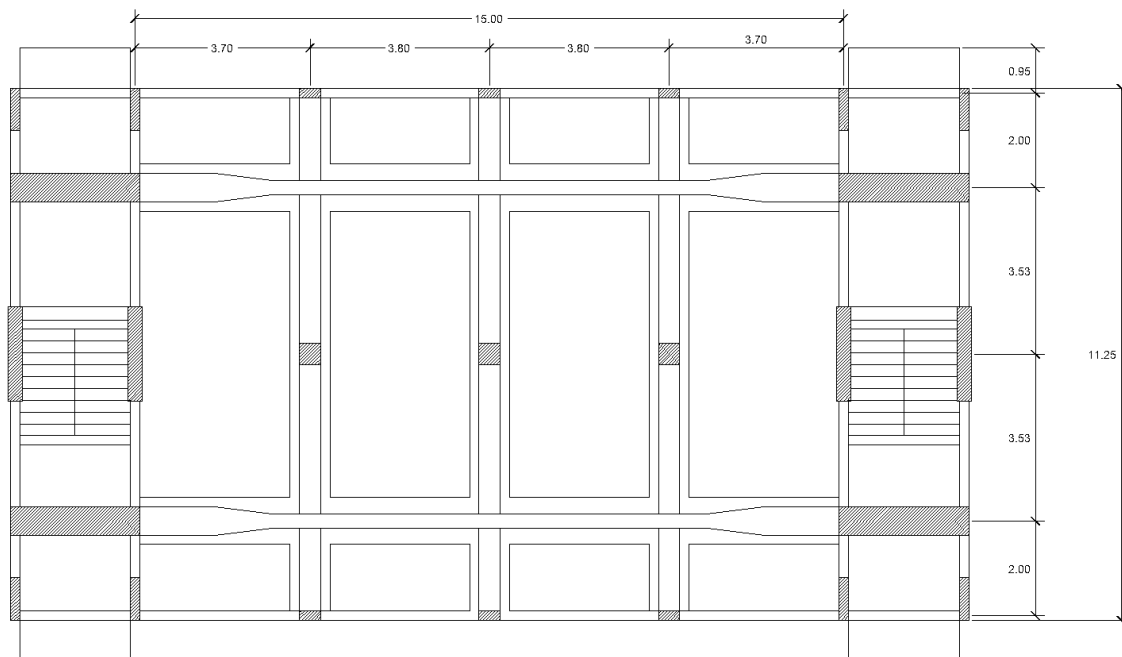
Croqui da grelha de vigas protendidas na cobertura
